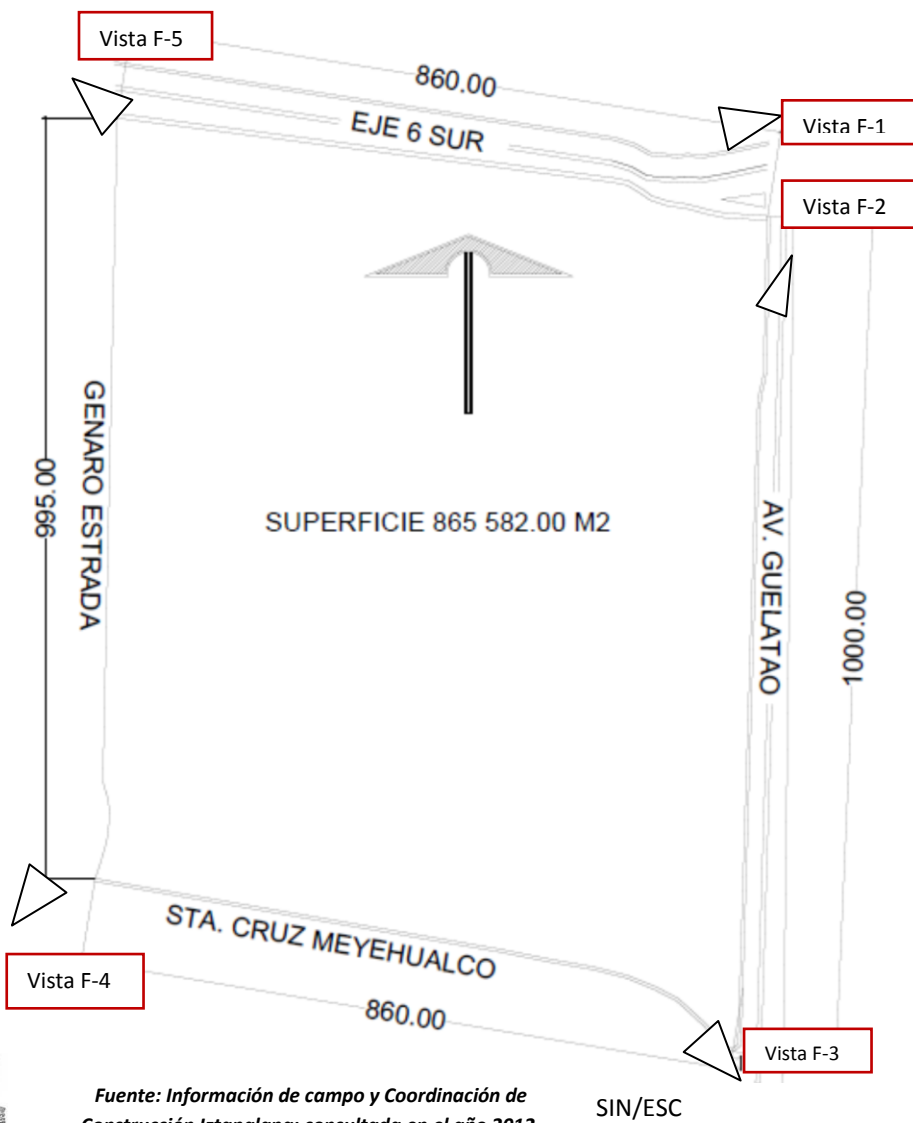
PLANTA DEL TERRENO (VISTAS)
